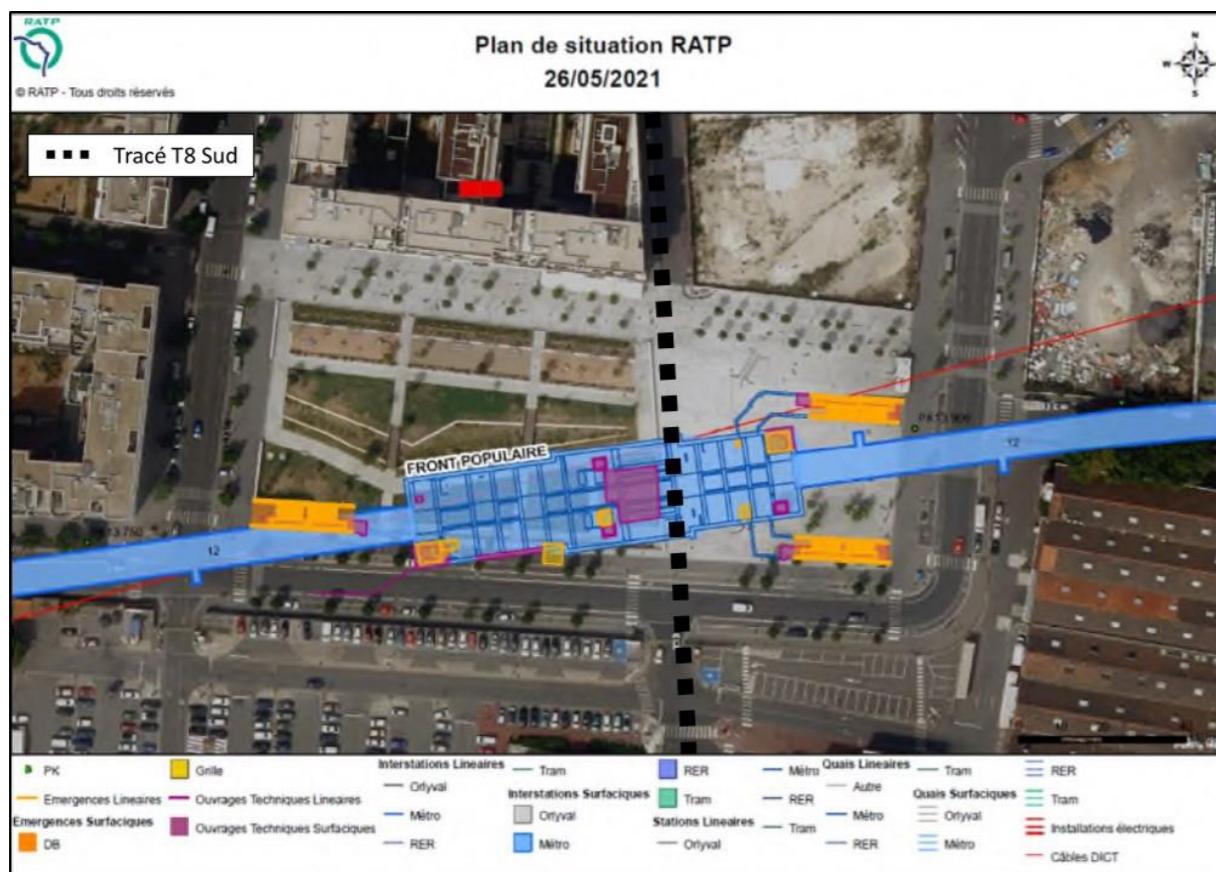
Boîte gare du M12 / Station Front Populaire – Plan de situation
